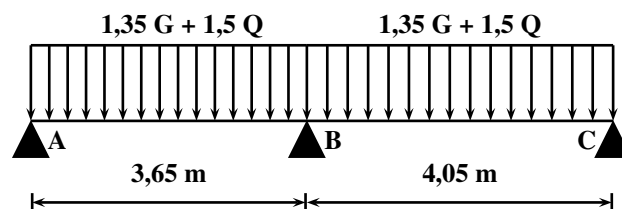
Poutrelle type 1 - cas 1 (ELU)
